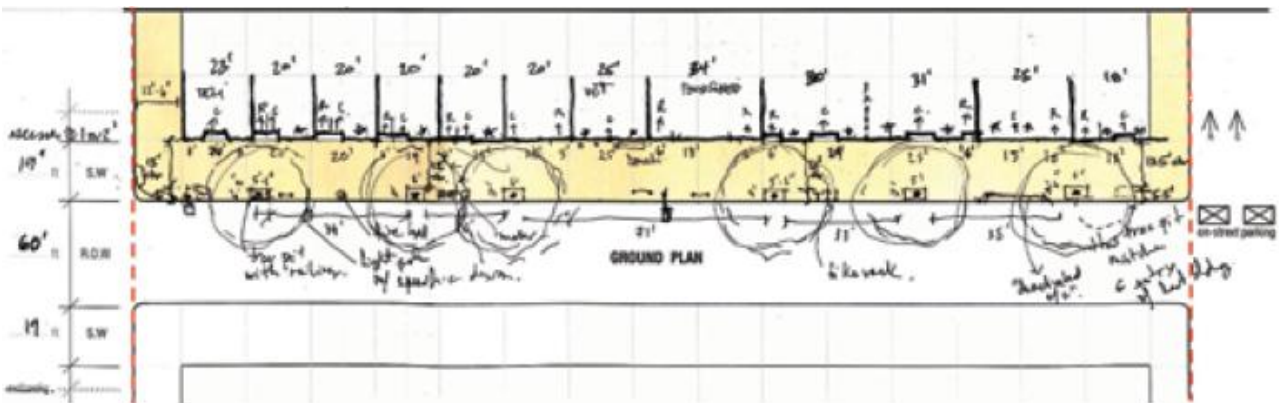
Planta de piso proposta pelo método norte-americano (CIDADE DE NOVA YORK, 2013).
